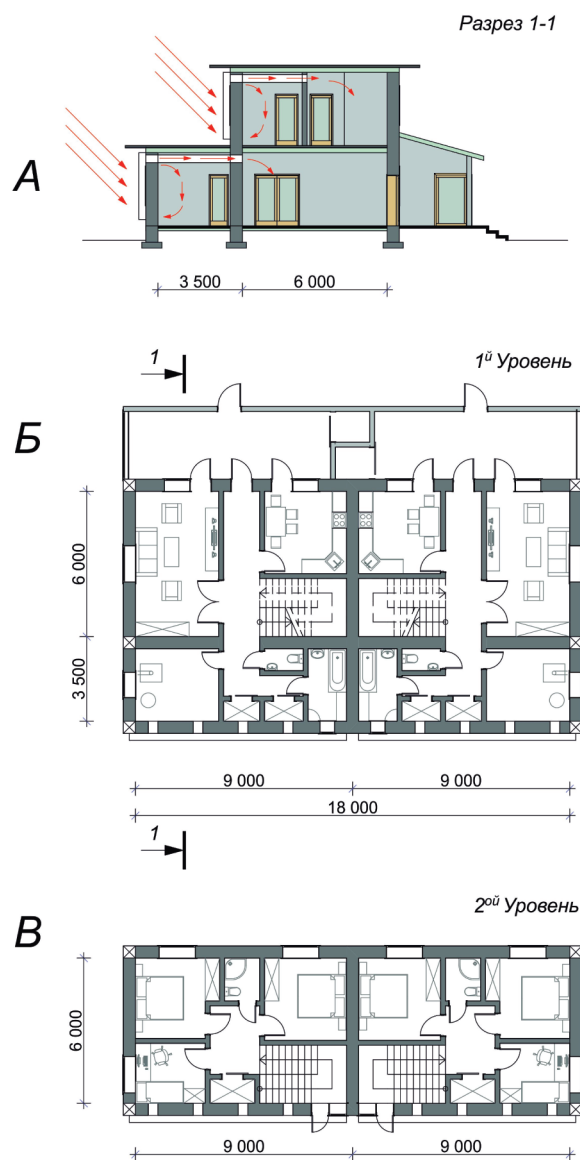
Геотеплодом в поселке Улугбек (Республика Узбекистан): А – разрез по А–А; Б – план первого уровня; В – план второго уровня
